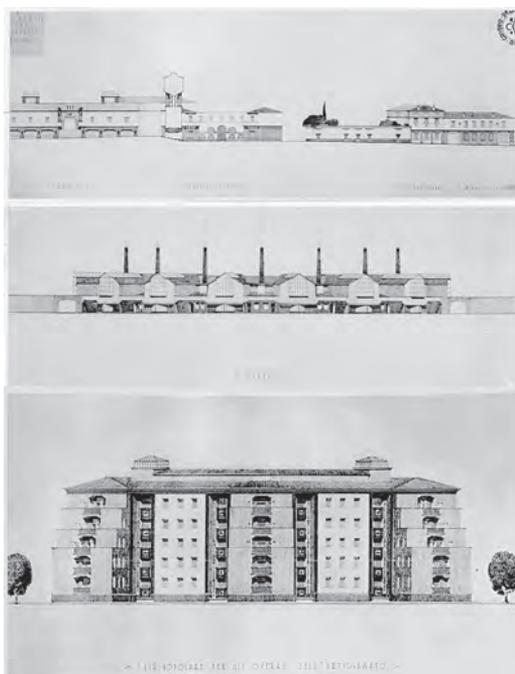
Gruppo Aschieri, Roma 1926. Sezione OP (in alto), sezione FE (al centro) e prospetto casa popolare (in basso) scala 1:200.
